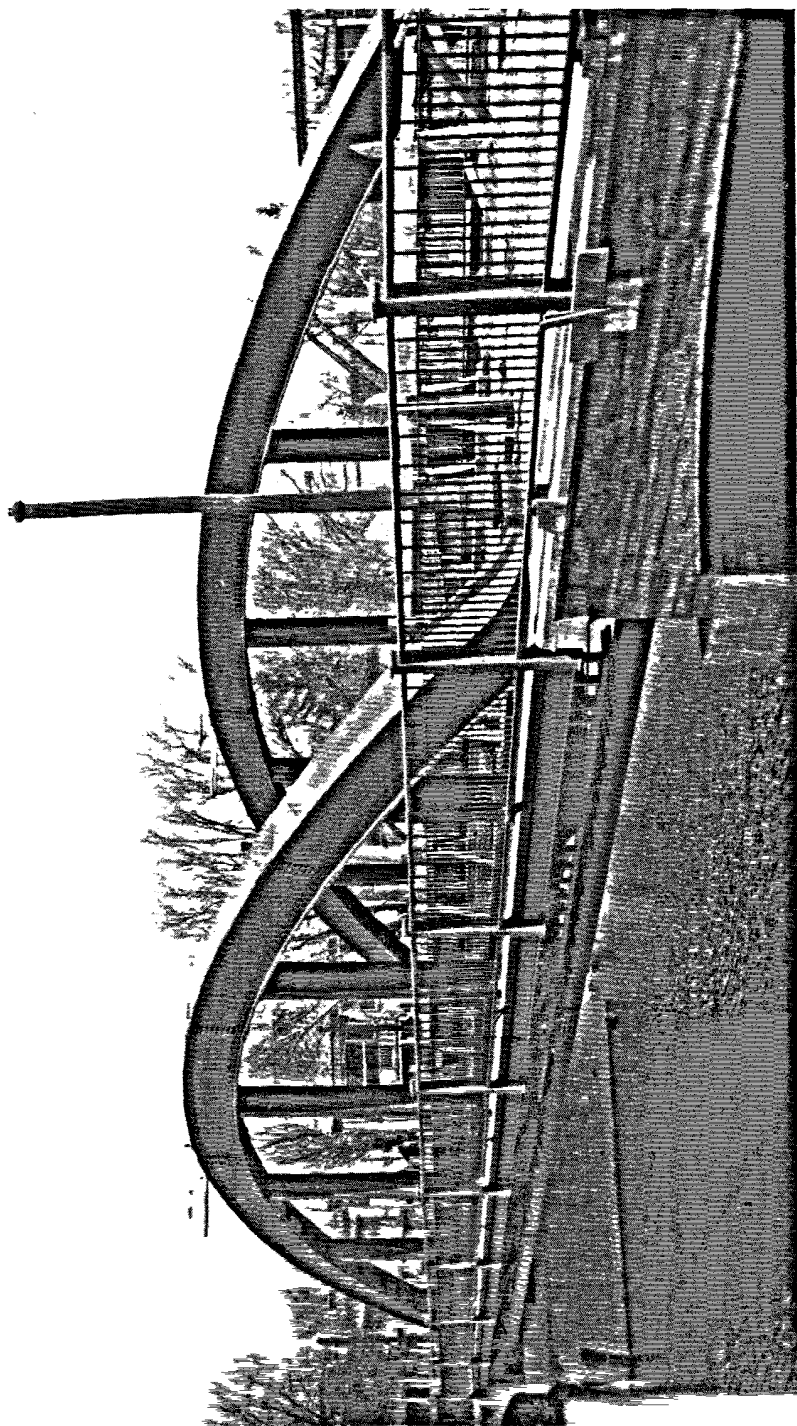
PONT SUR LA RIVIERE CHATEAUGUAY A ORMSTOWN, COMTE CHATEAUGUAY. (ROUTE MONTREAL-MALONE.—Ce pont, dont la longueur totale est de 220 pieds, est formé d'une arche métallique de 140 pieds et de deux travées adjacentes en béton armé de 40 pieds chacune reposant sur piliers et culées en béton. Largeur de la voie charretière: 27 pieds. Un trottoir de 4 pieds et 6 pouces. Construit en 1934.
